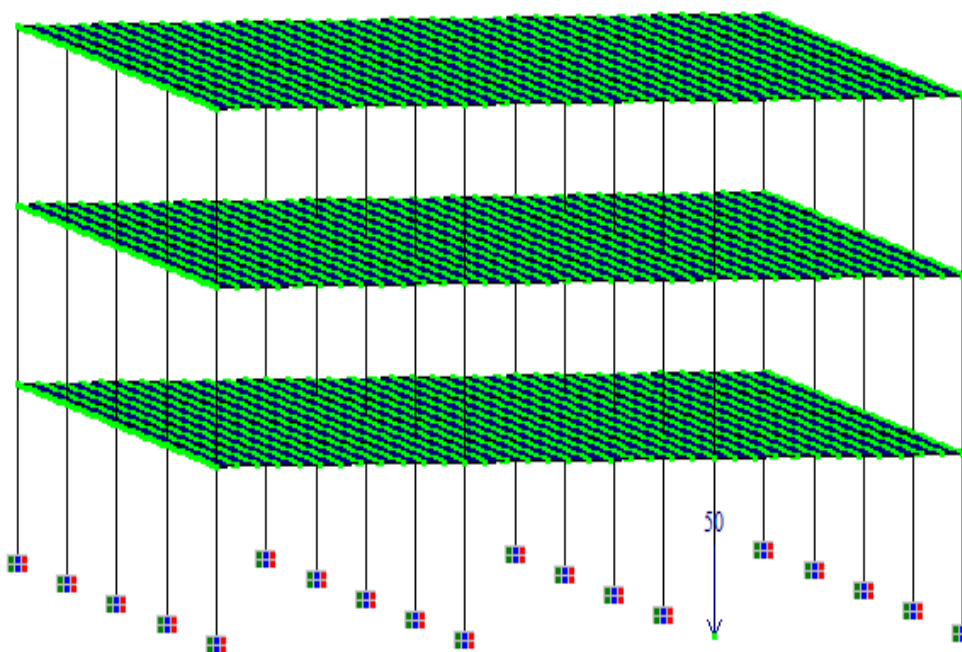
Schéma illustratif du modèle d'étude du bâtiment avec planchers en hourdis à 3 niveaux avec un chargement vertical sur le poteau de rive
